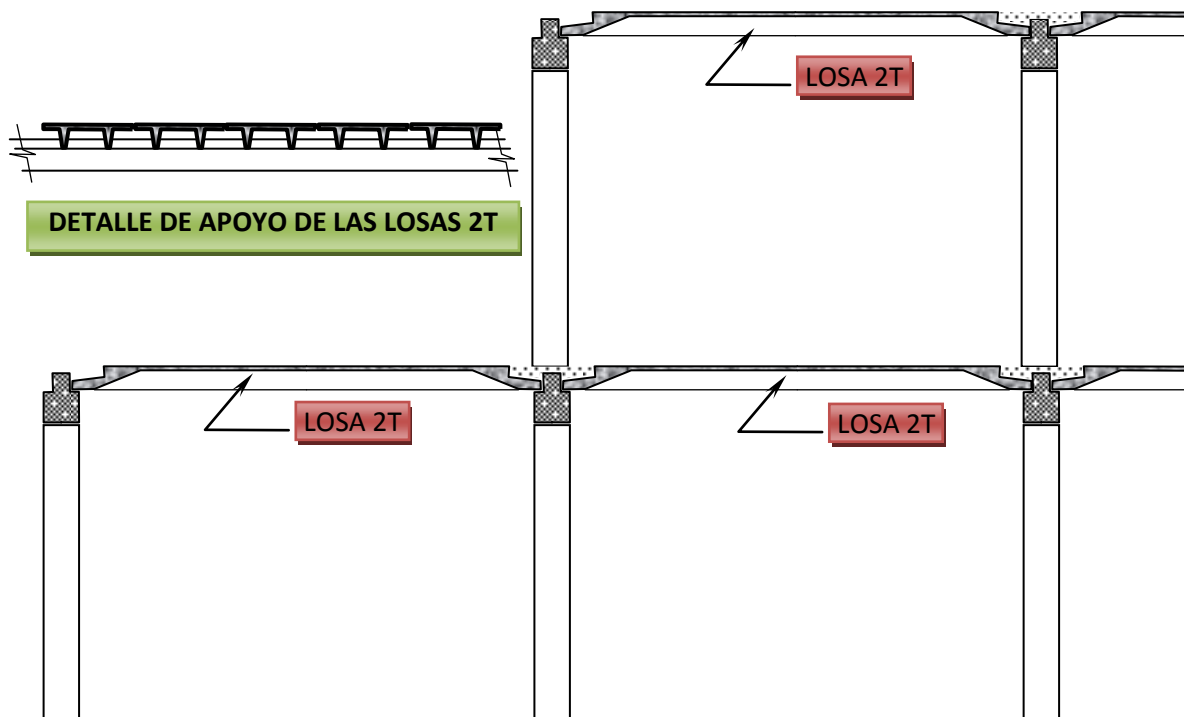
26 Detalle de los pórticos del sistema Girón y empleo de la losa 2T.
